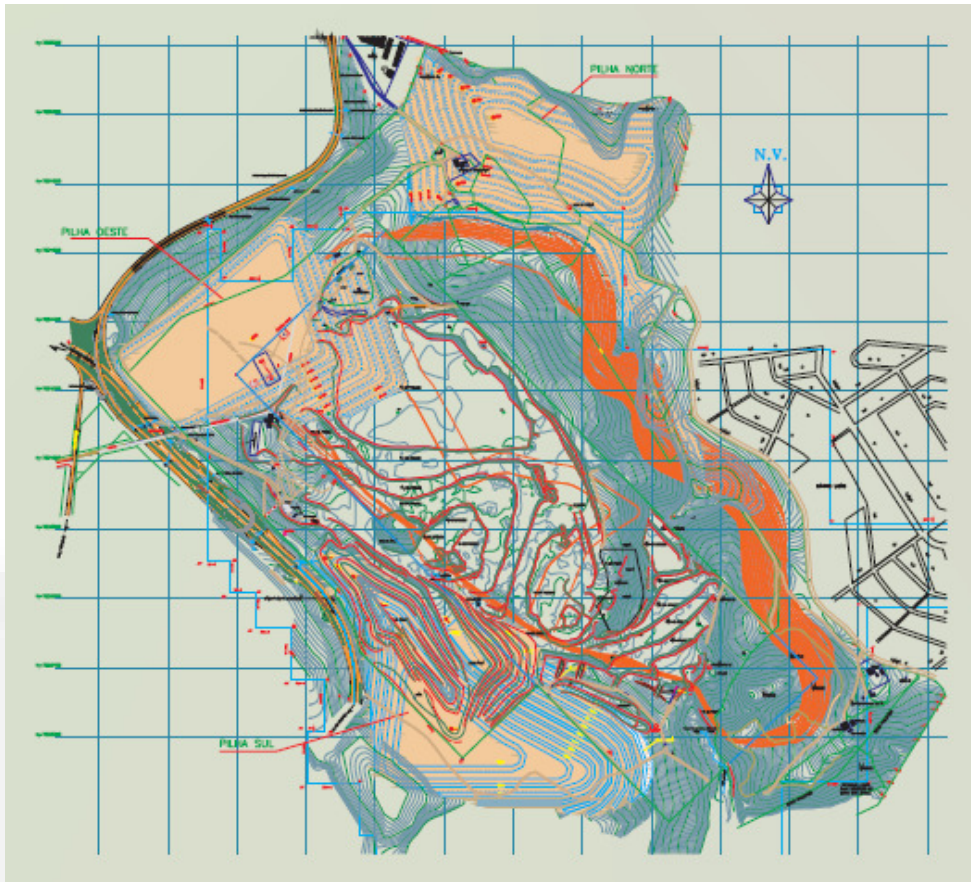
Planta demonstrando a cava atual e área de expansão da lavra (pit final) em vermelho (polígonos minerários DNPM 002.318/1945 e 831.584/1990 e pilhas de estéril (creme hachurado). Foi acordado um recuo do pit final (vermelho) apresentado no projeto inicial, na porção leste/nordeste da cava.
